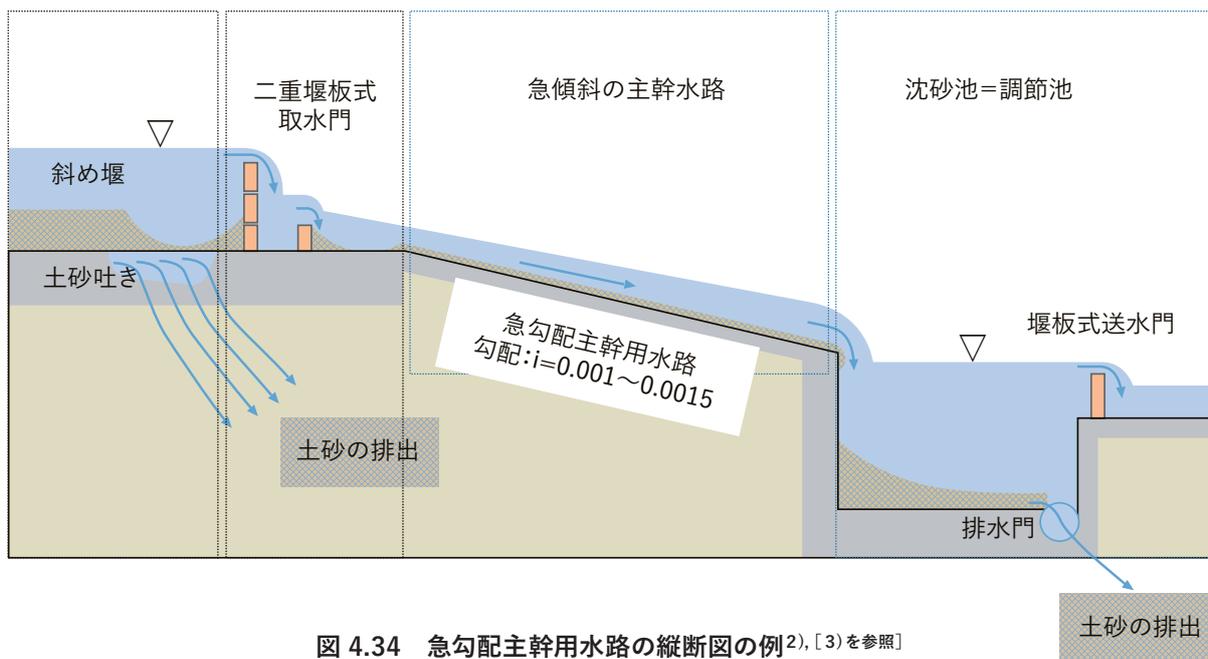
急勾配主幹用水路の縦断面図の例<sup>2)</sup>, [3)を参照]
